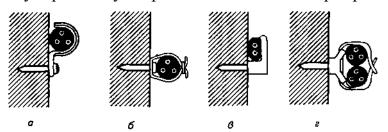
Крепление защищенных проводов и кабелей на бетонных и кирпичных основаниях:
